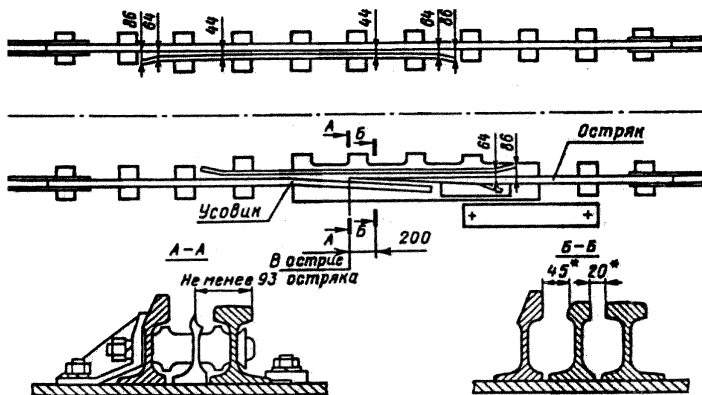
Башмакосбрасыватели типов P50, P65 колеи 1520 мм
